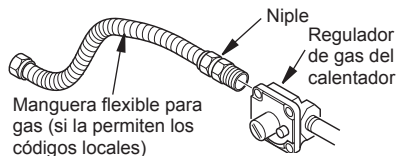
Conexión de la manguera flexible para gas al regulador de gas del calentador
